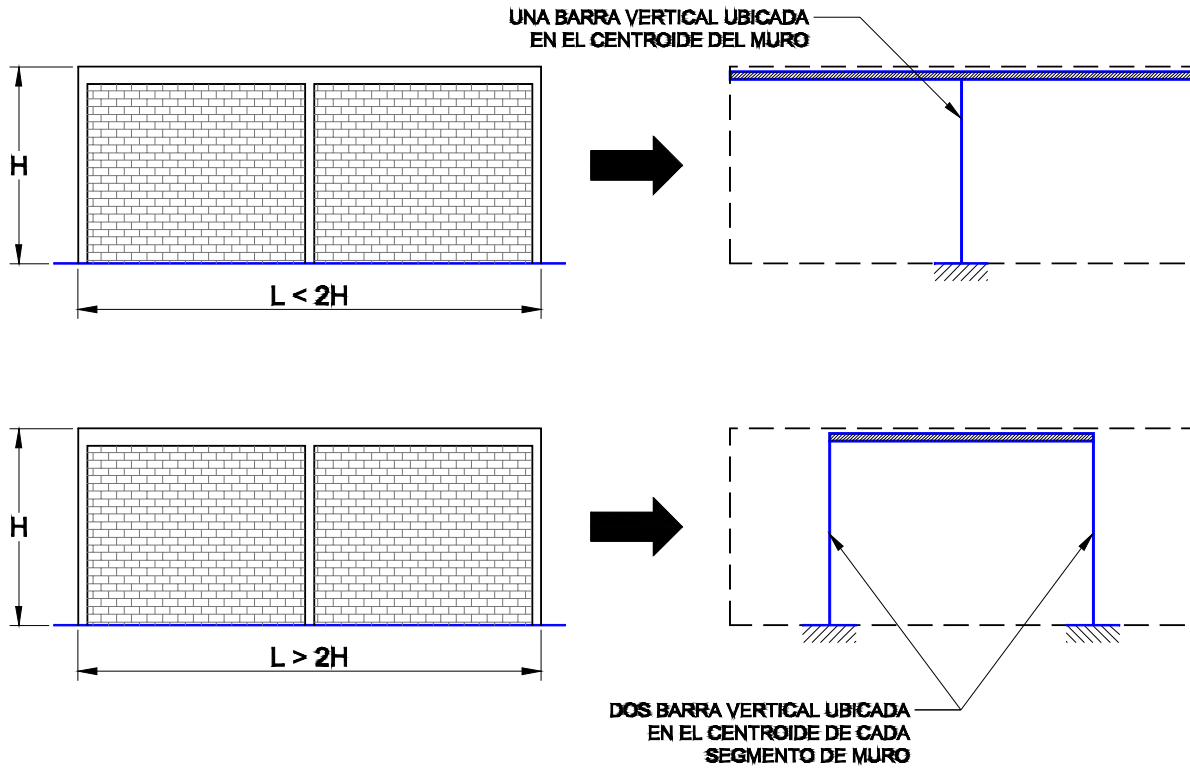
Recomendaciones división de muros de mampostería confinada por el método de la columna ancha
